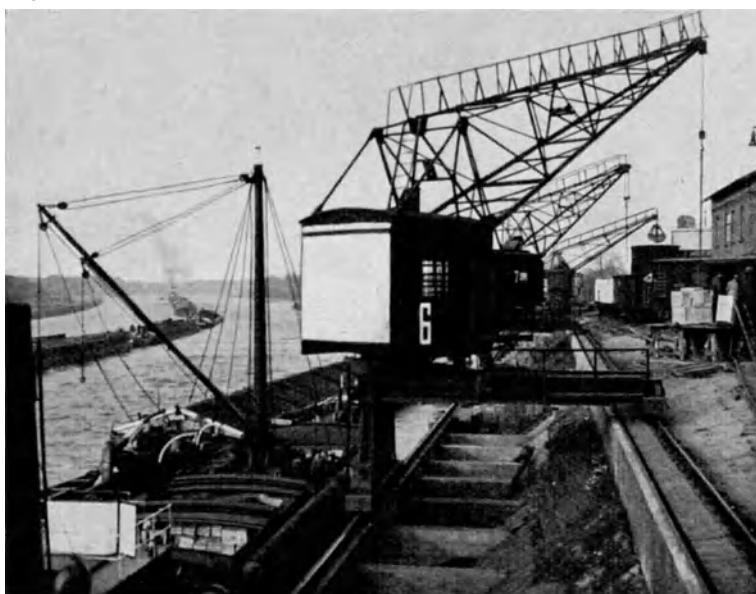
Privathafenanlage zu Wallwitzhafen.
